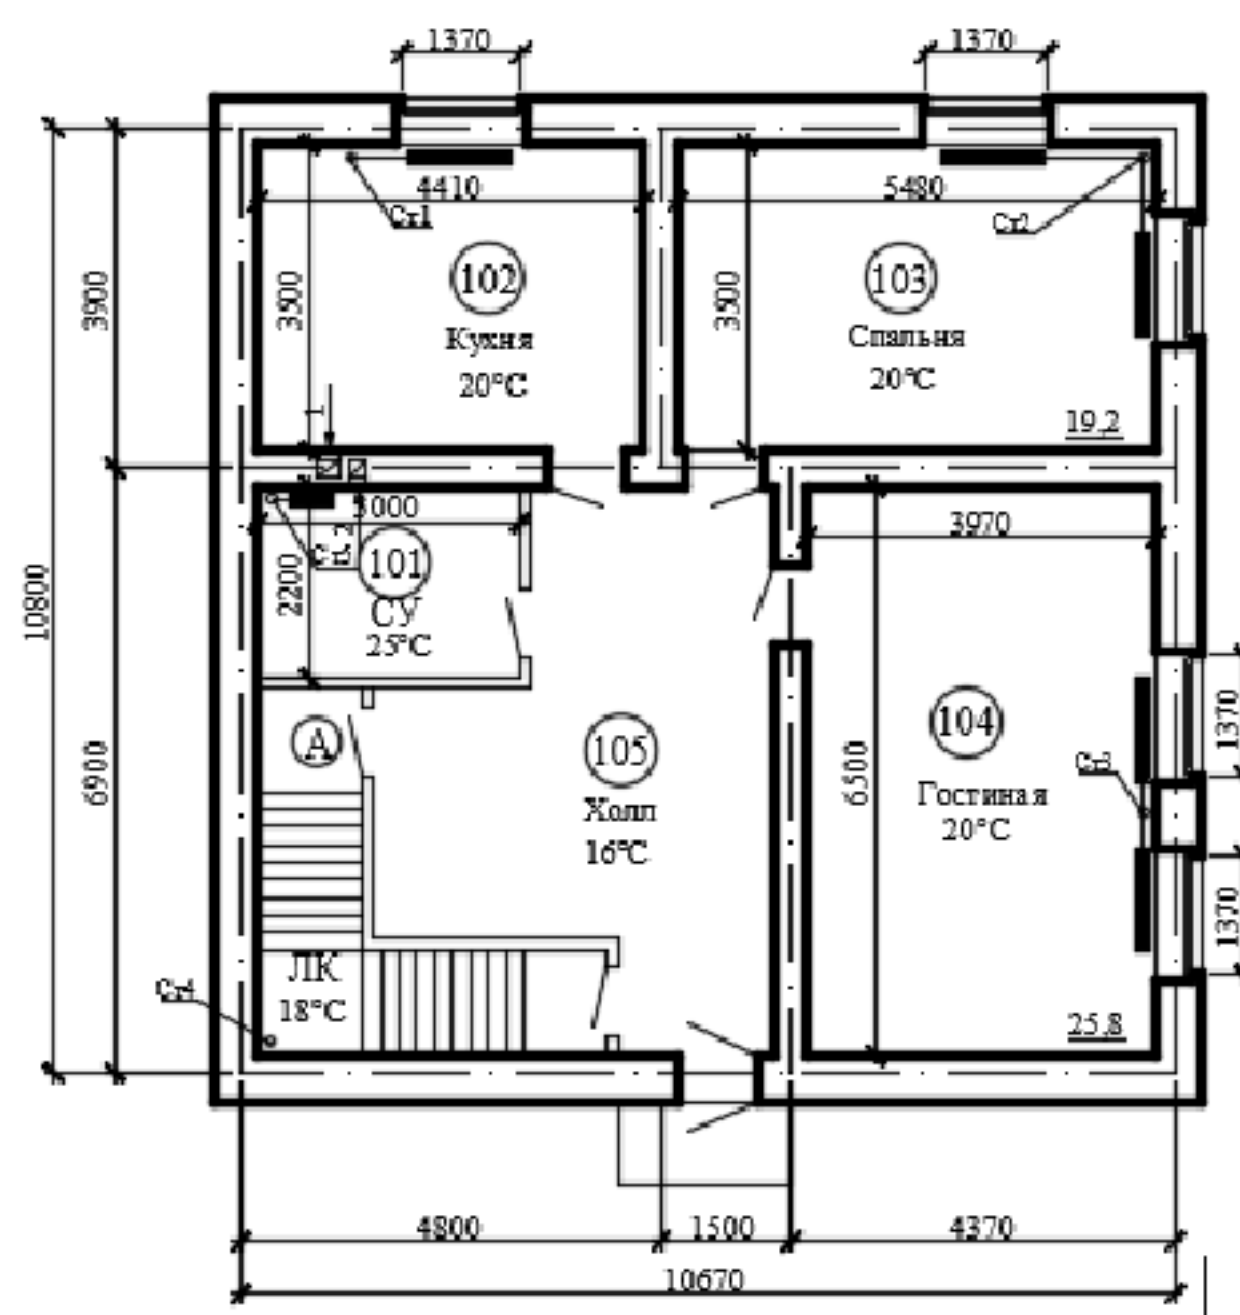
План первого этажа двухэтажного жилого дома
